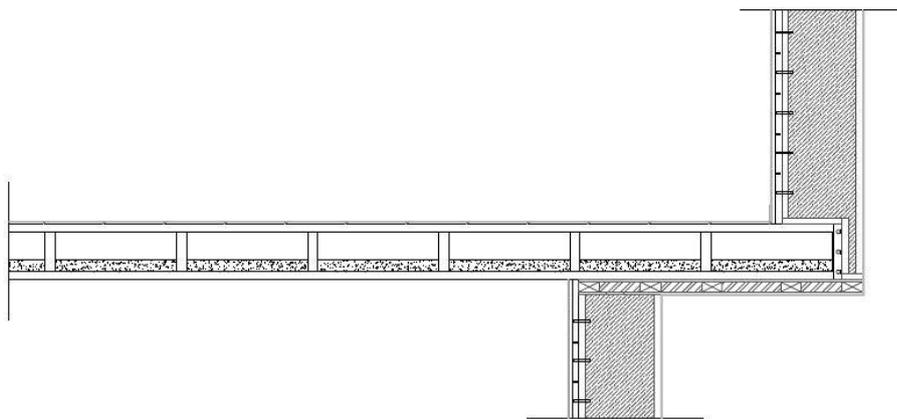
Apoyo de estructura en voladizo. Fuente: Elaboración propia.
